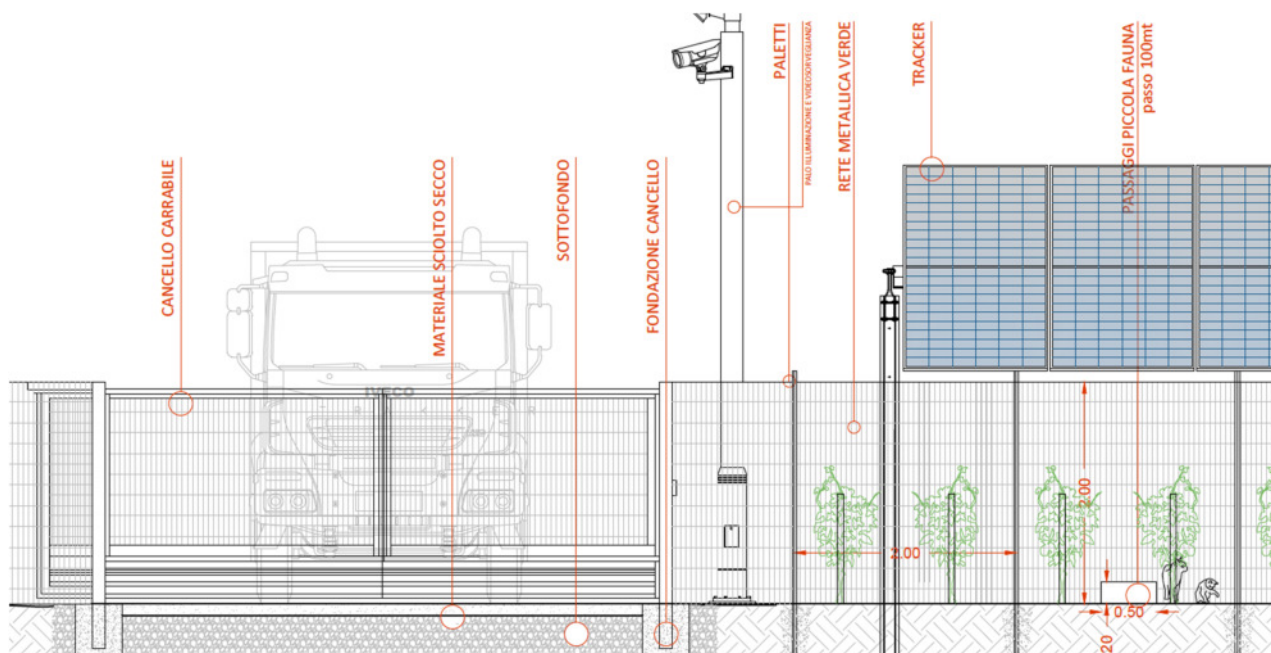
Particolare in prospettiva recinzione (rif. FV.ALC01.PD.F.02)
